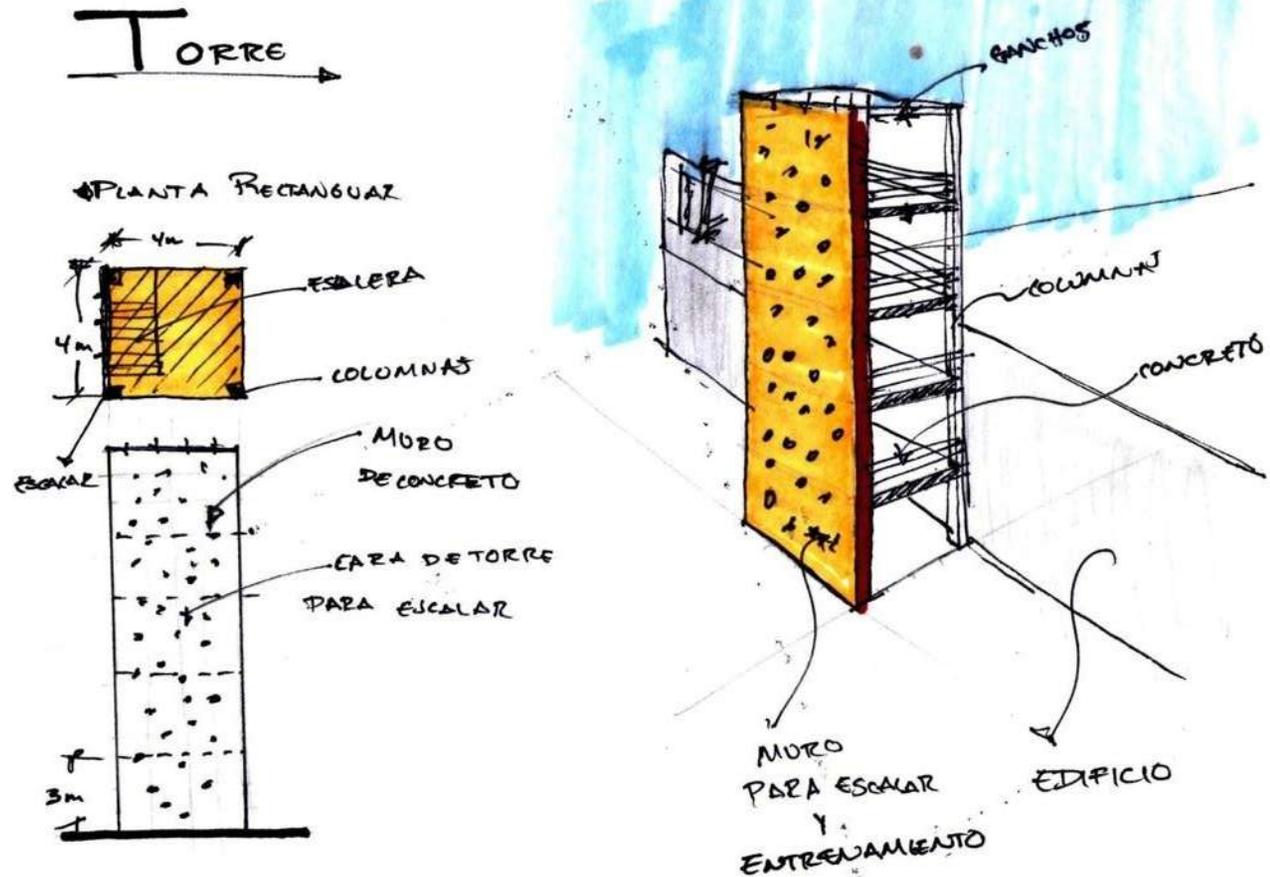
Bosquejo de la torre de secado y muro de escalar.
